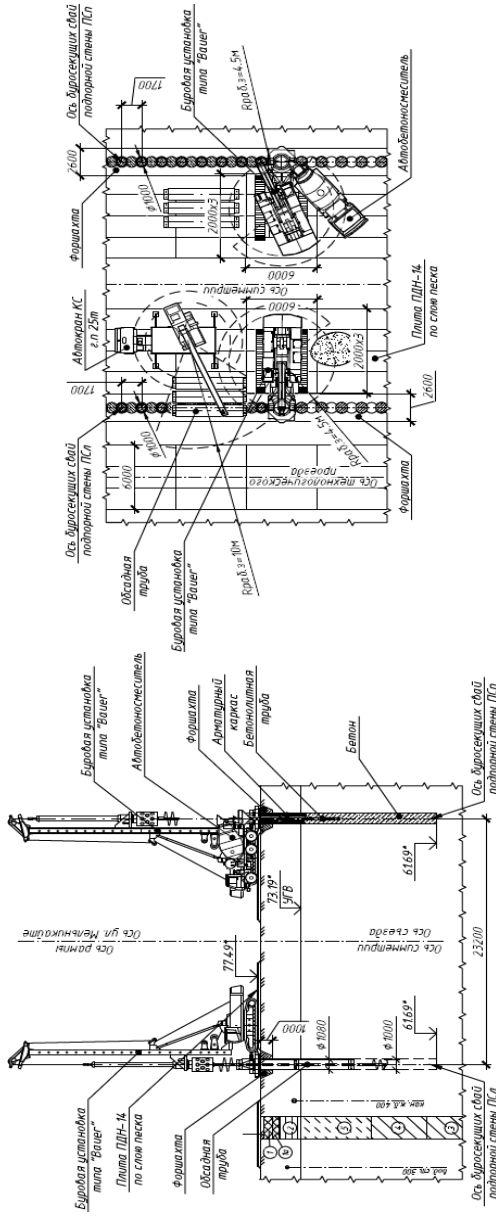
Бурение и бетонирование скважин не армируемых (опережающих) свай [6].
